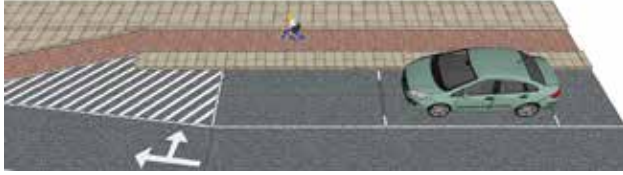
Değirmenaltı Sokak plan-1, plan-2
